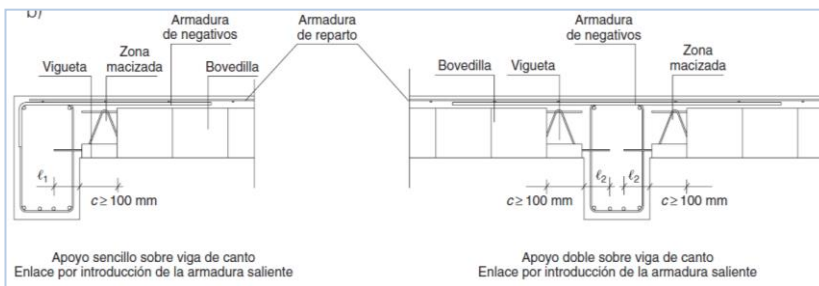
y 16. Apoyo sobre viga de canto. Enlace por introducción de la armadura saliente
